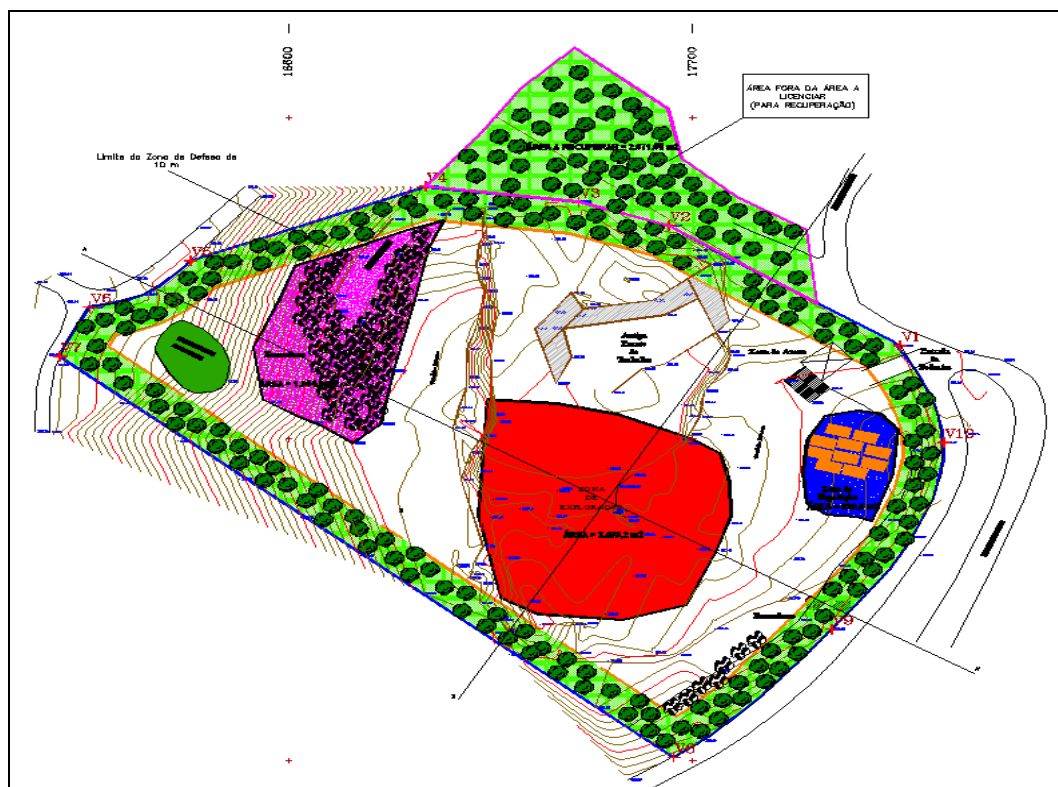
Áreas de exploração - Planta do Zonamento.
